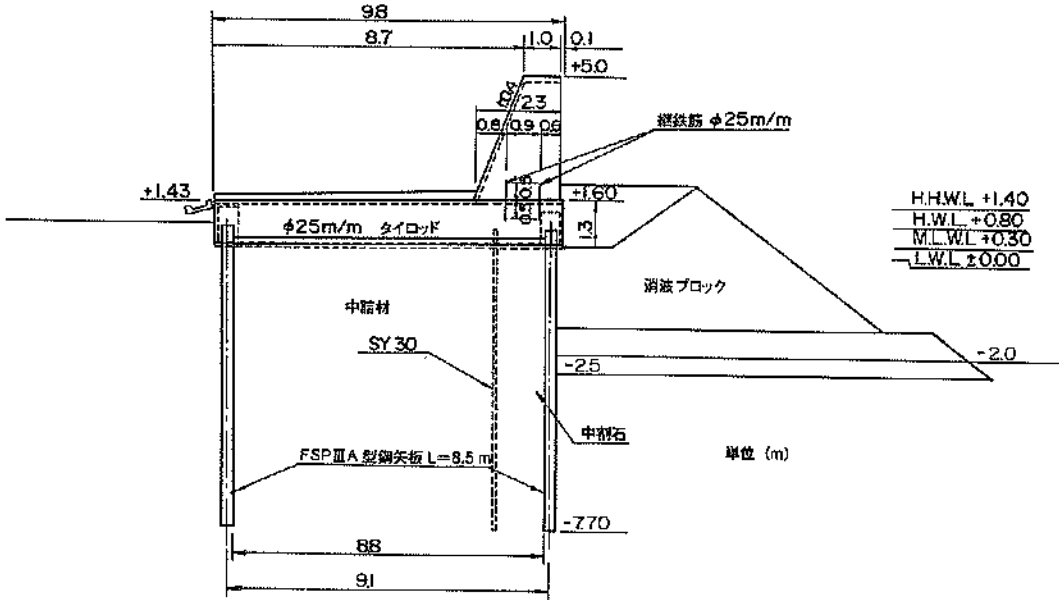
被災状況平面図・縦断面図（上磯漁港、②南護岸・西護岸）
